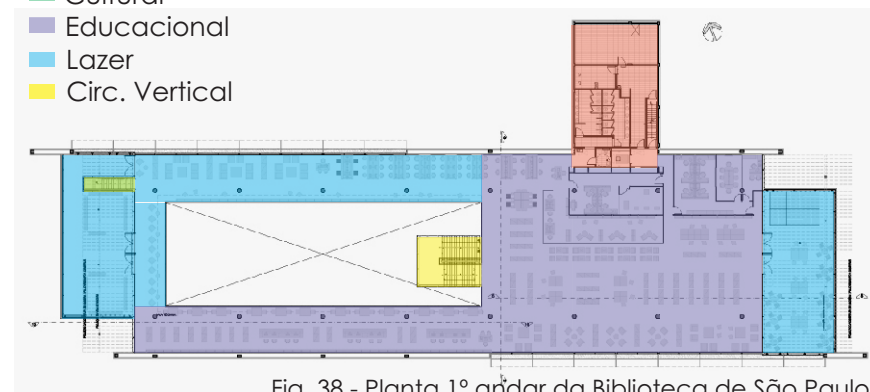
Planta 1º andar da Biblioteca de São Paulo
